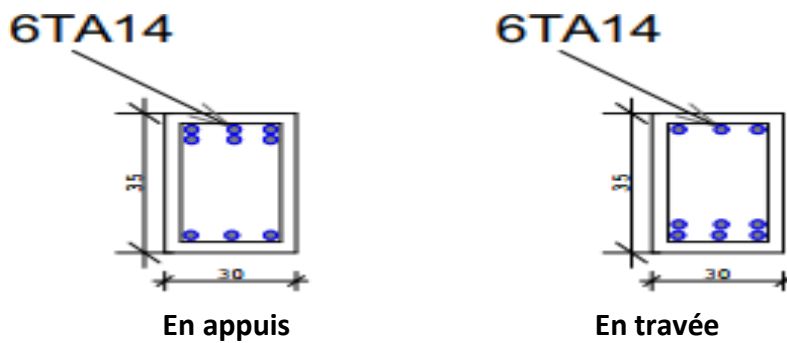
Ferrailage de la poutre secondaire (30x35).
